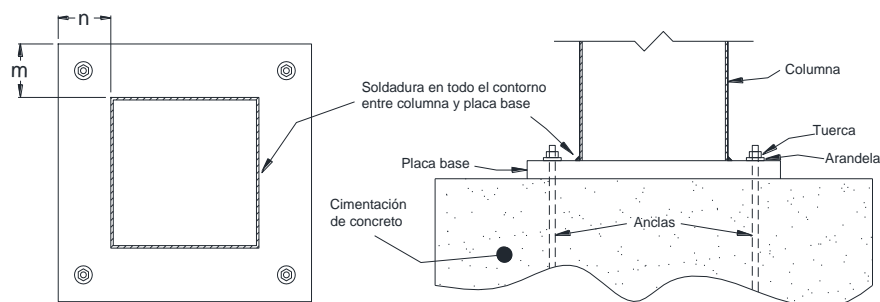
Apoyo tipo apernado columna – placa base – concreto
